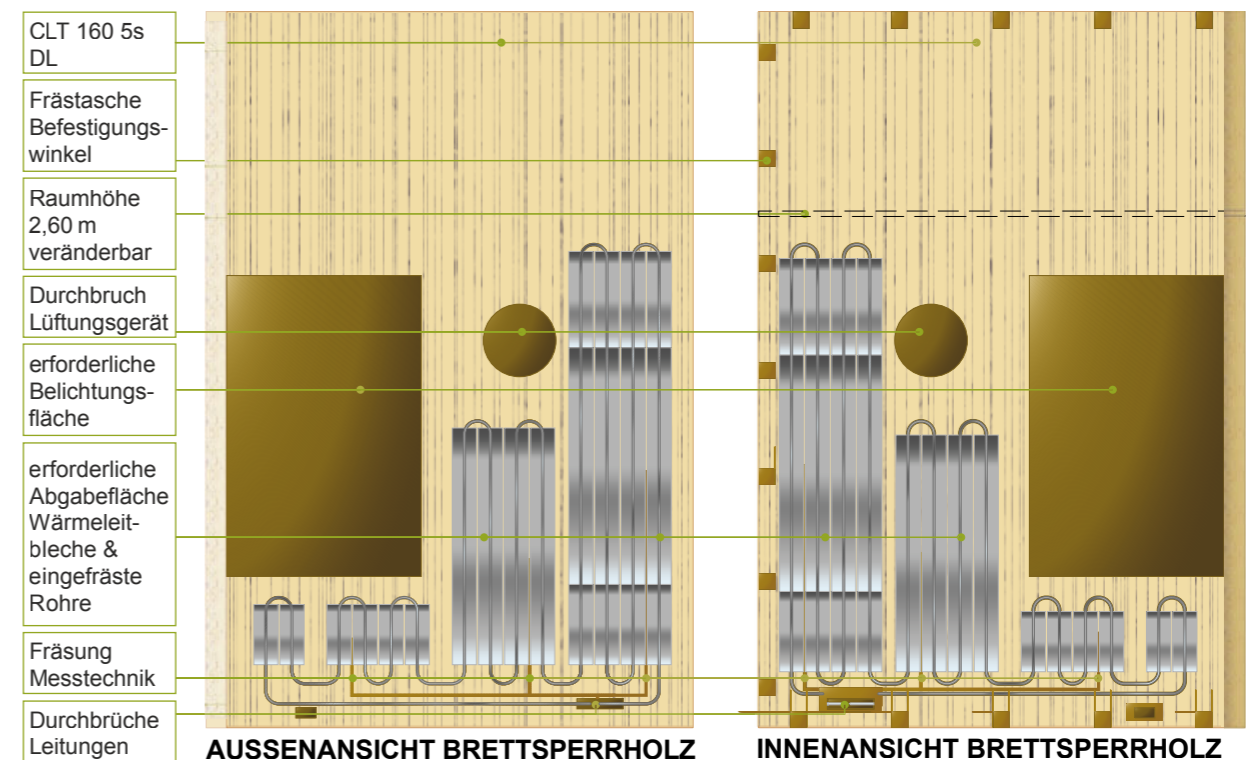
Außen- und Innenansicht CLT-Platte
